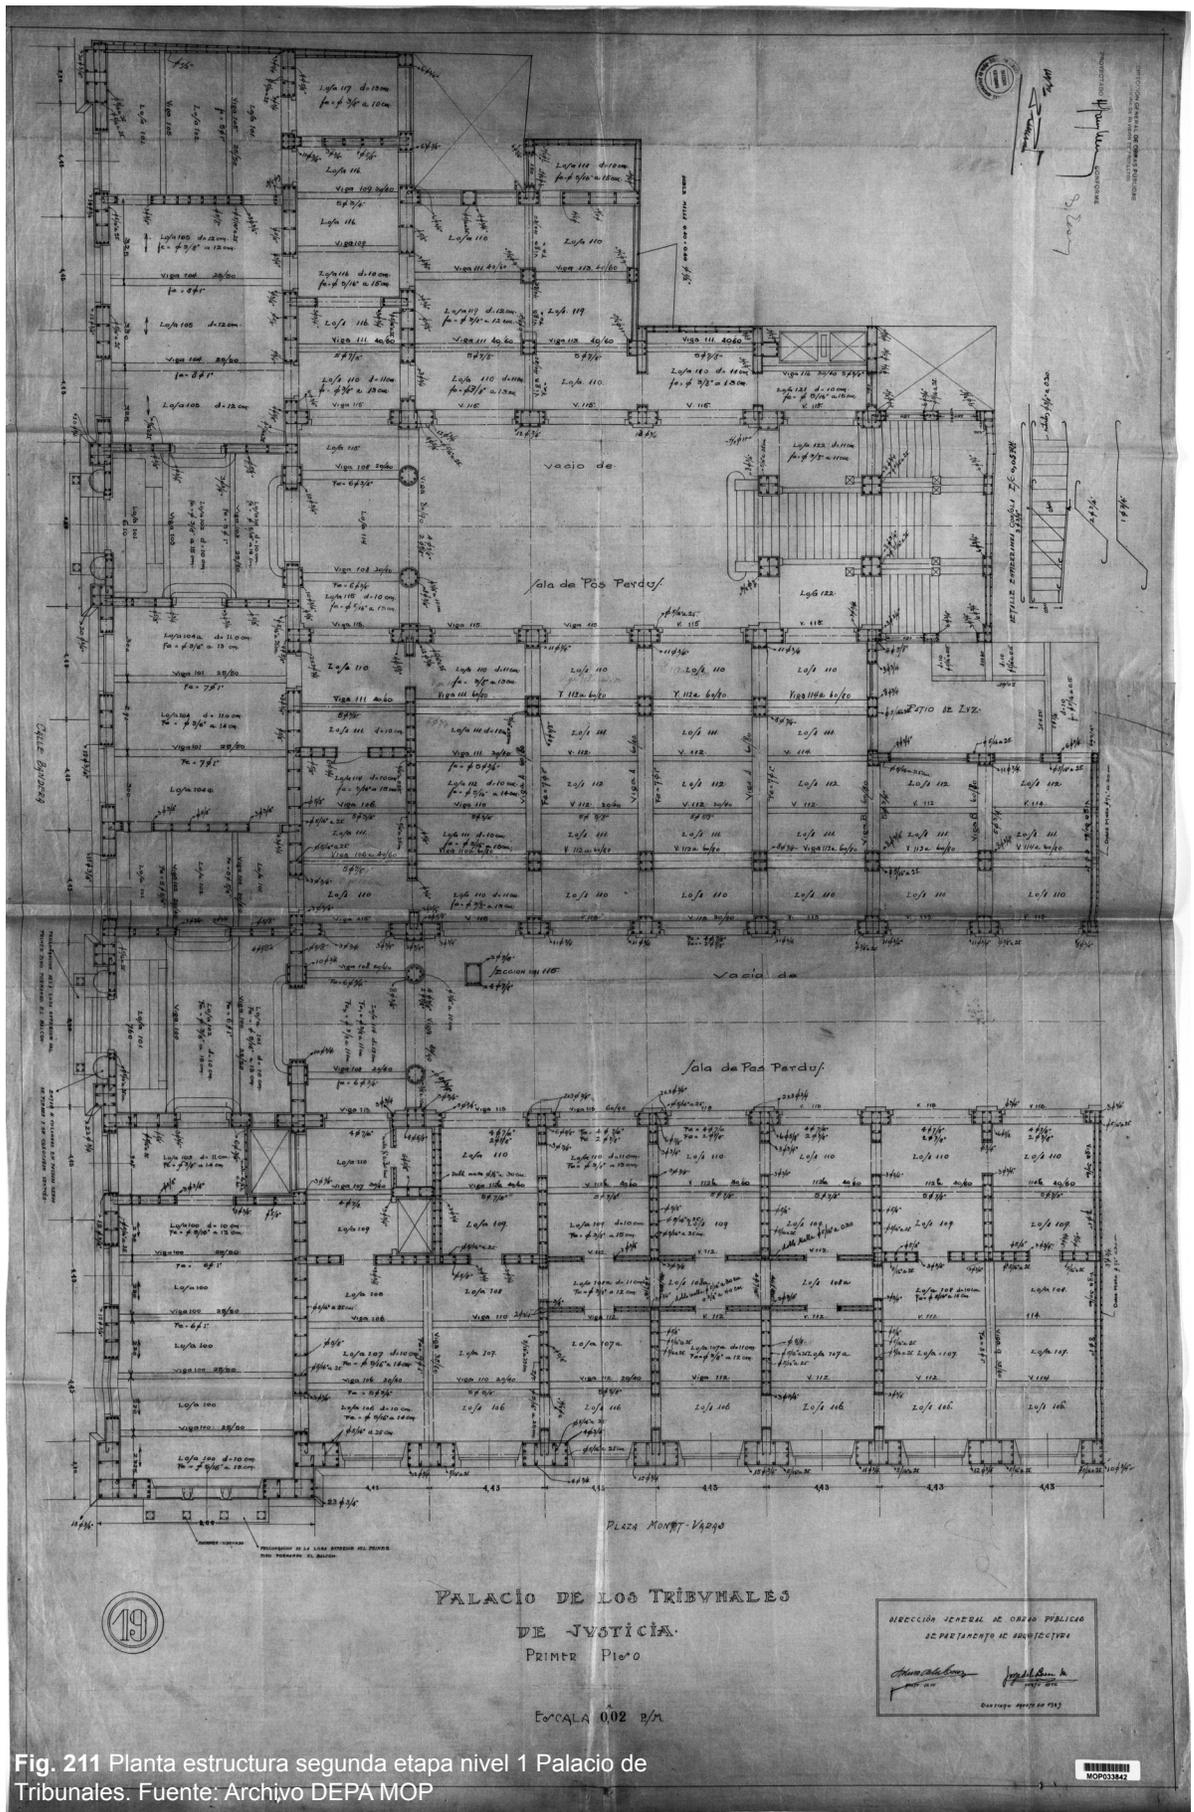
Planta estructura segunda etapa nivel 1 Palacio de Tribunales. Fuente: Archivo DEPA MOP
